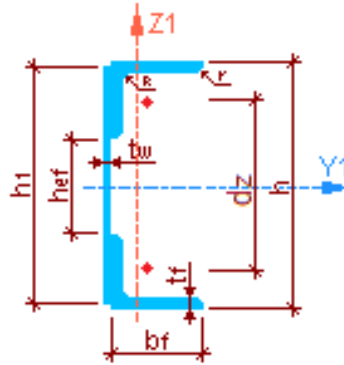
Схема профиля Швеллер сварной из листа и уголков
